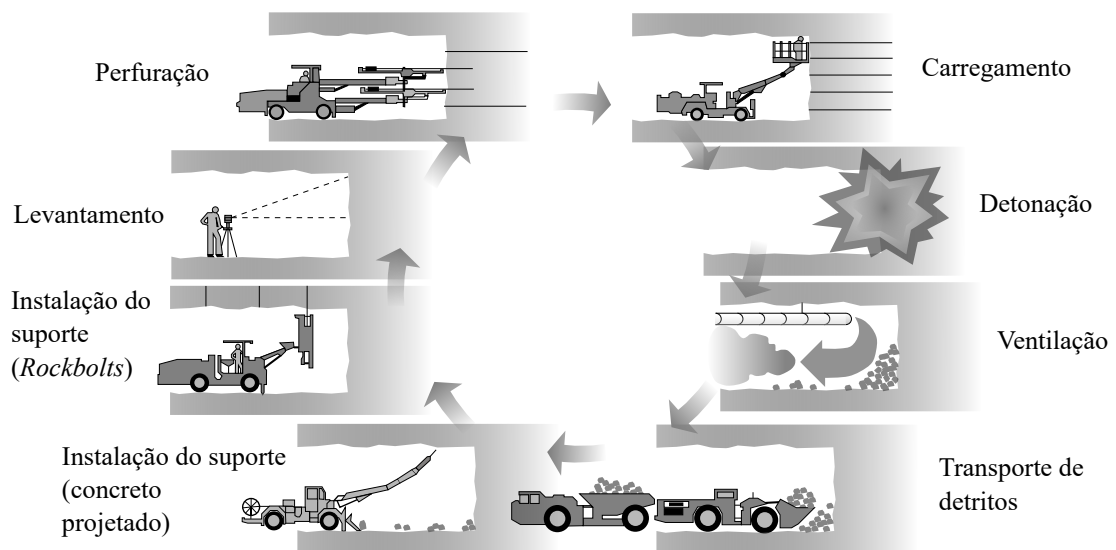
Sequência executiva do método de construção por perfuração e detonação (adaptado de Heiniö (1999))
